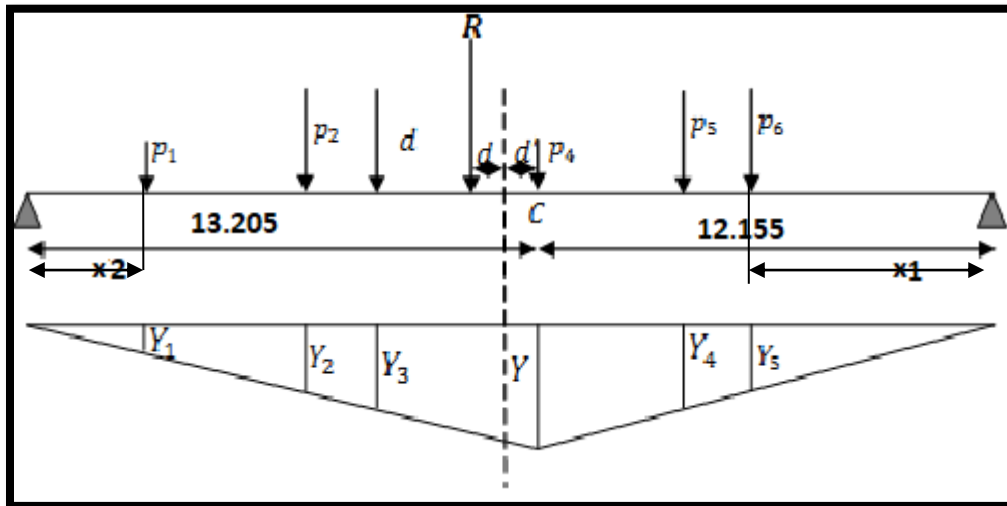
Disposition de deux camions sur la chaussée (sens longitudinale)
